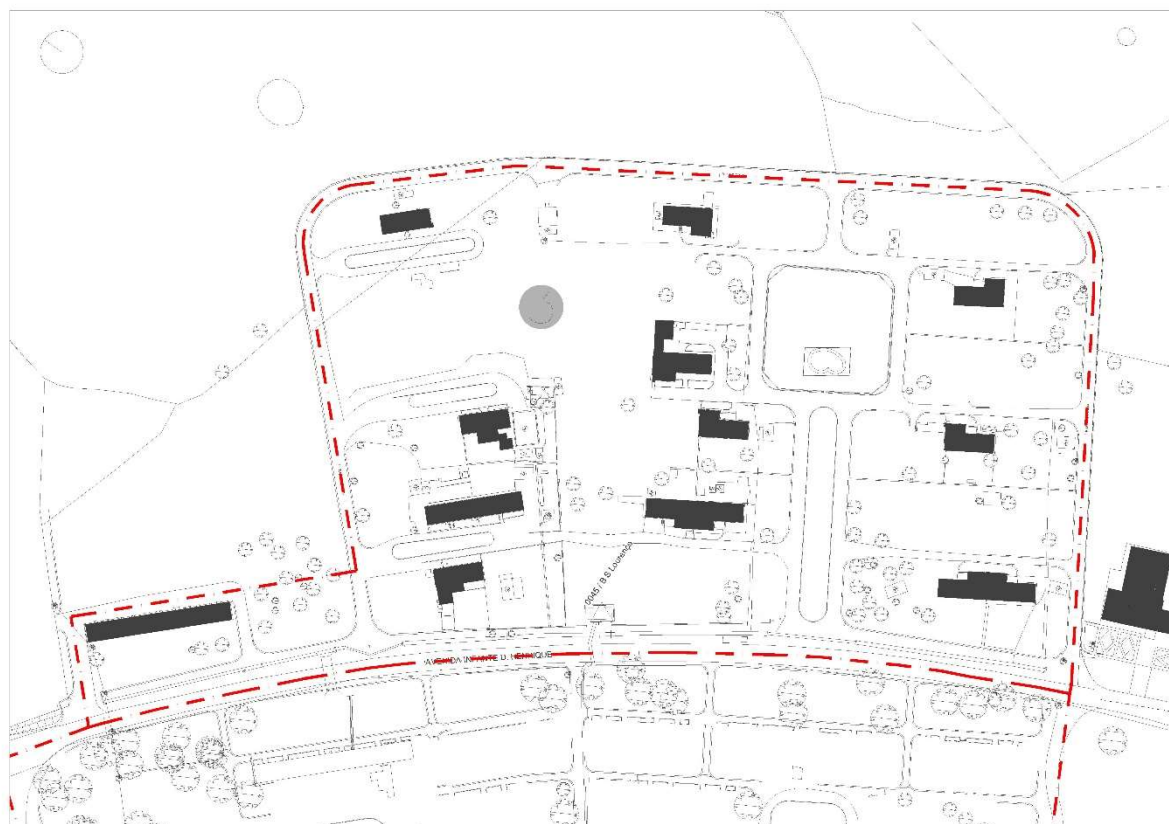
Planta do Bairro de São Lourenço (Extrato de Planta Cedida Pelas Ilhas de Valor)
